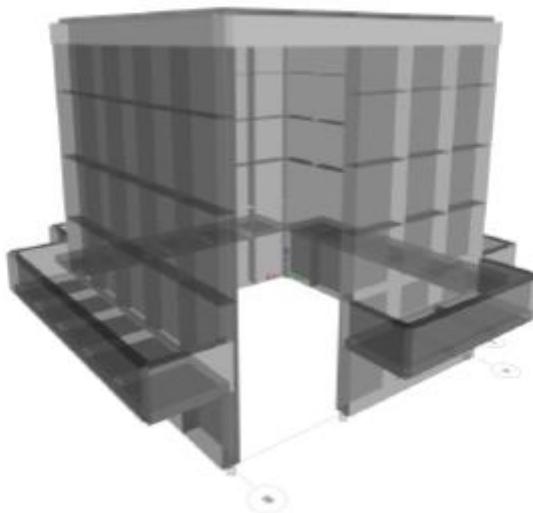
Vista 3D del modelo estructural – vano de acceso.
